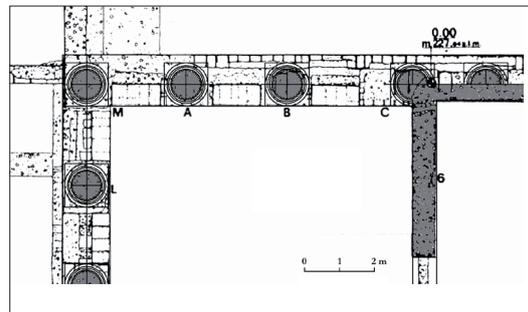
La soluzione dell'anta per un elemento baricentrico al plinto di fondazione.
